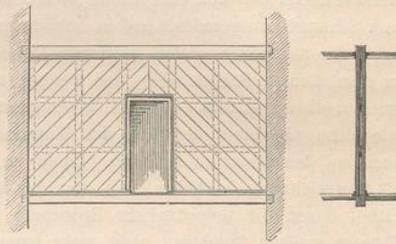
Wand. Gesprengte Bretterwand, bei der Fachwerk mit einer absprengenden Bohlenlage benagelt ist.
